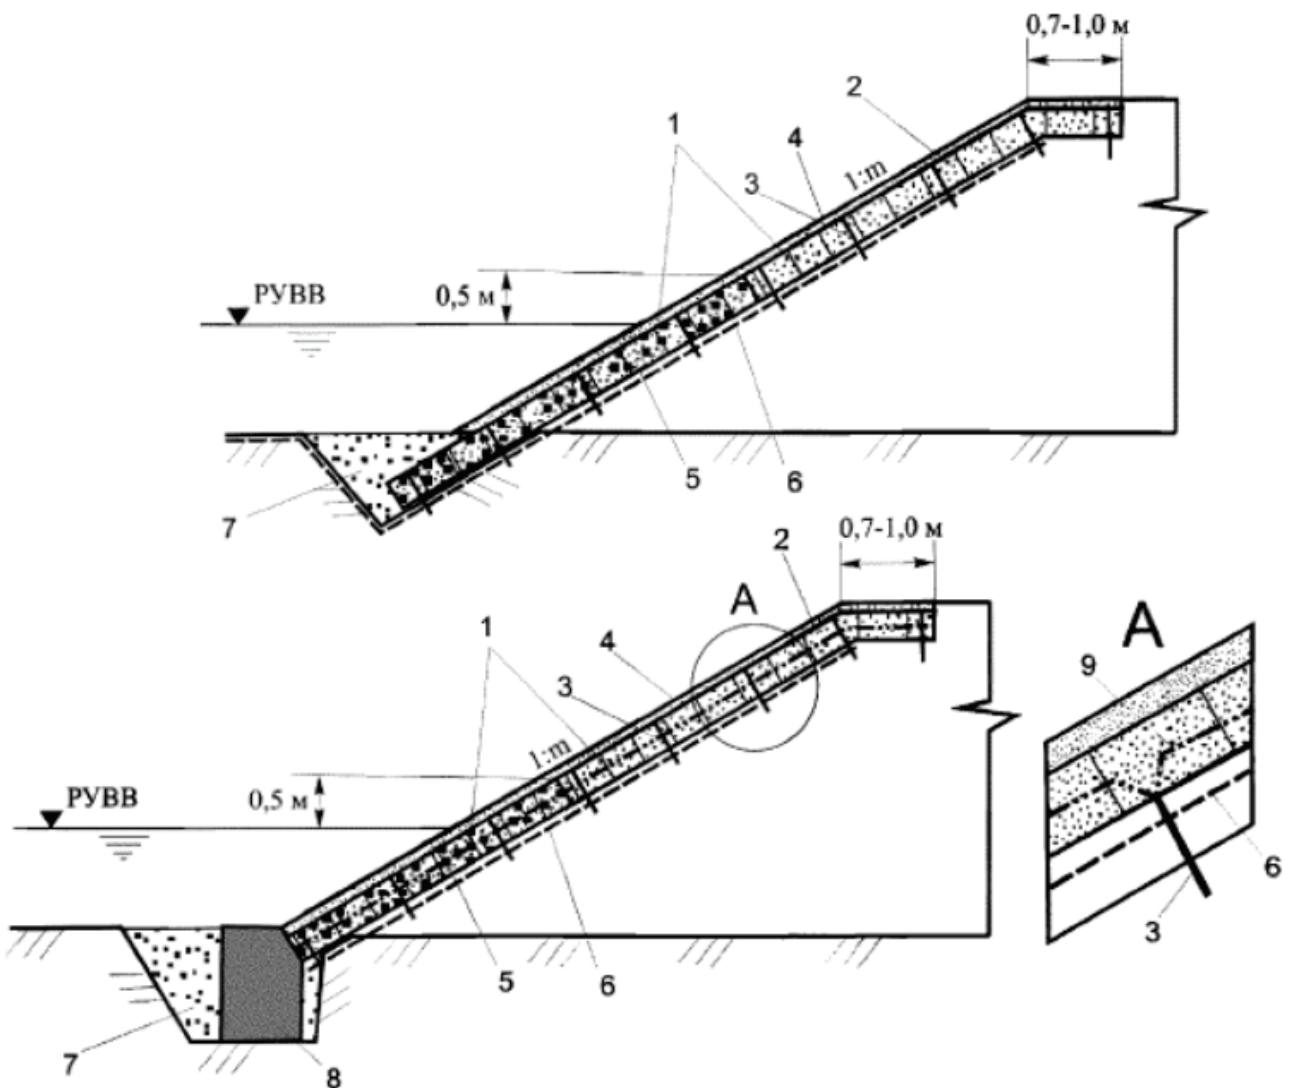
Конструкция укрепления подтопляемых откосов; Узел А — тросовое крепление
